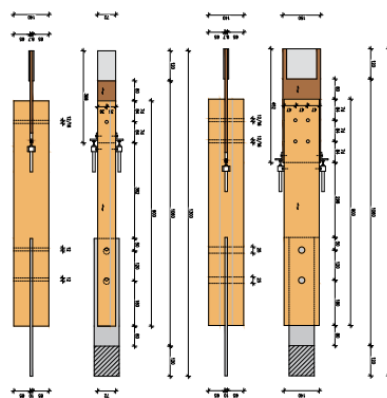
Figura 6. conexiones de madera con pasadores y placas ranuradas de compuesto de bambú
